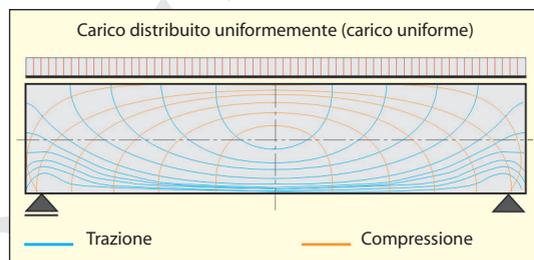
tensioni (traiettorie) in una trave di cemento armato.
